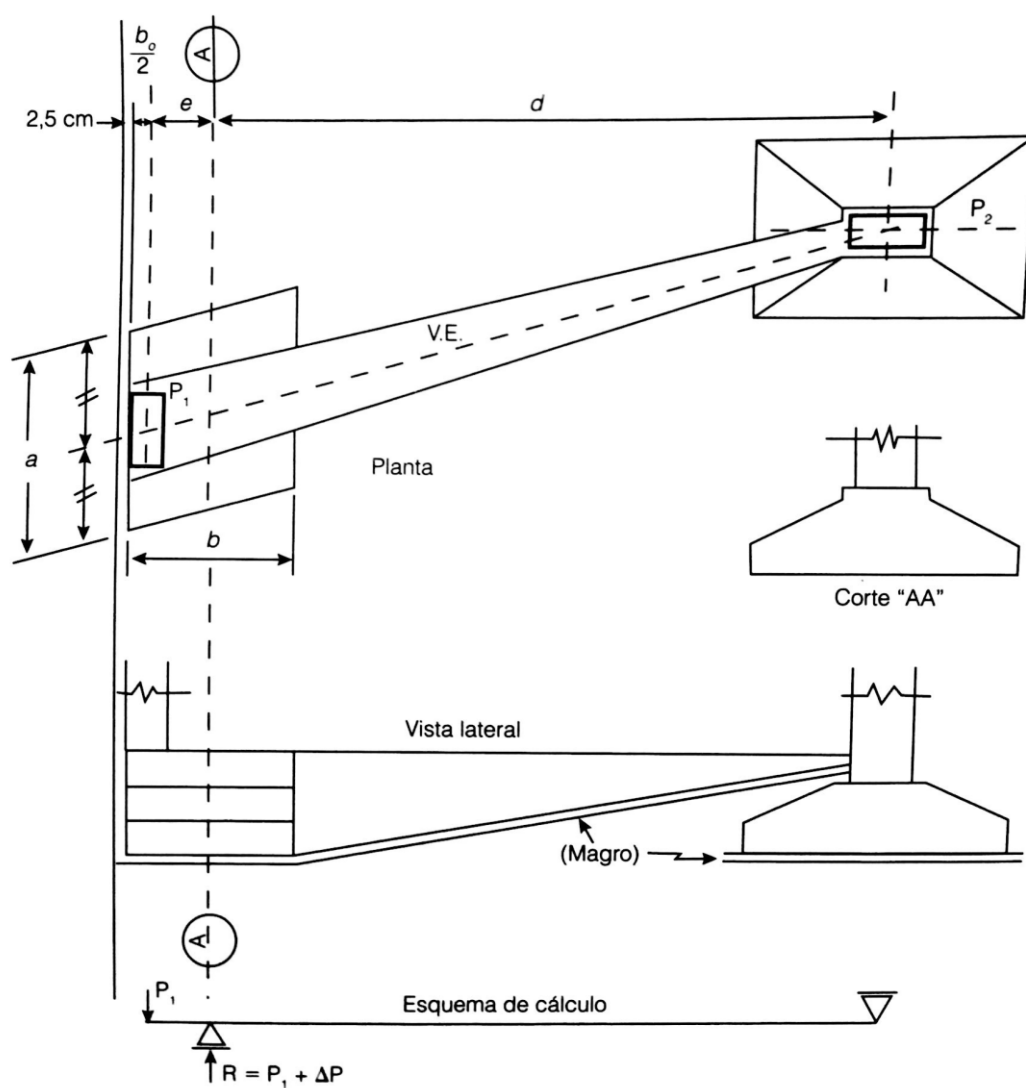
Desenho esquemático de uma viga de equilíbrio – Em planta e corte
